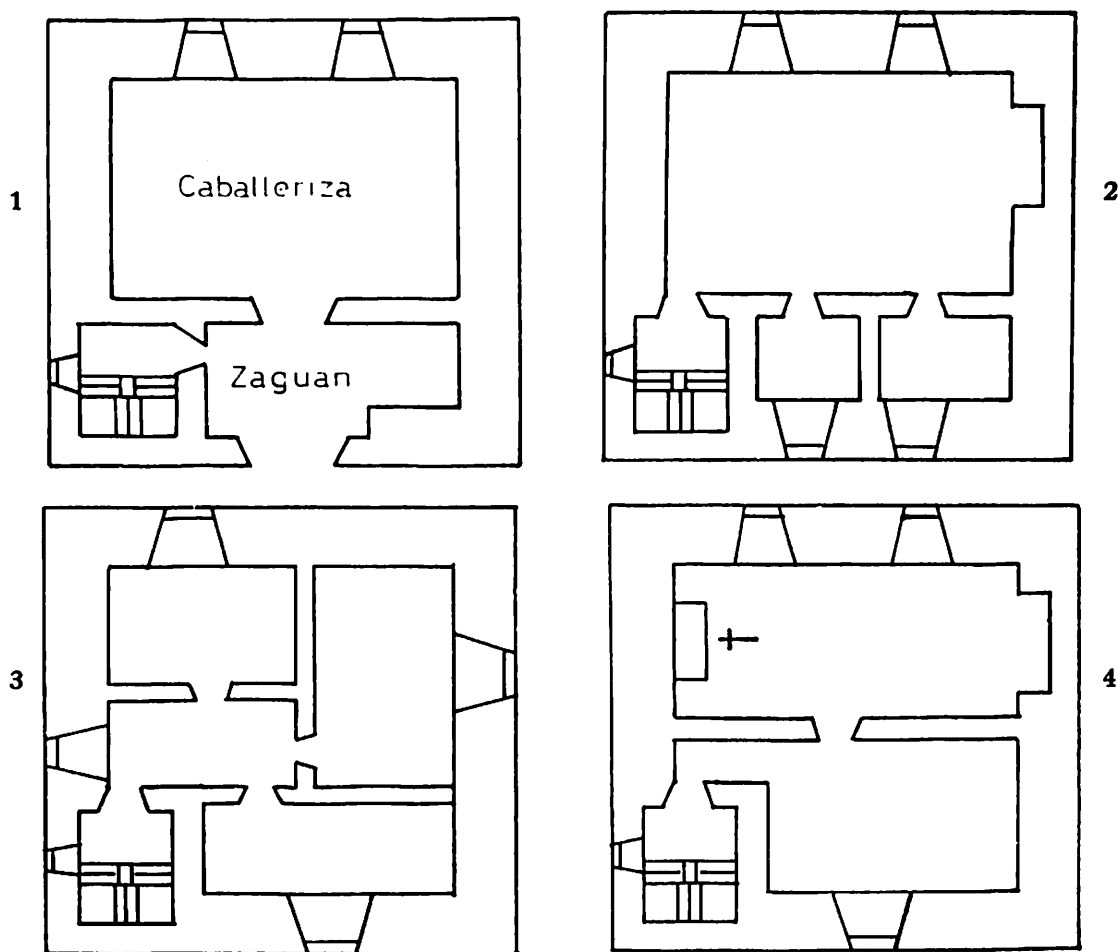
Plano de la torre de la Parada: 1. Planta baja. 2. Planta segunda. 3. Planta tercera. 4. Planta superior.
